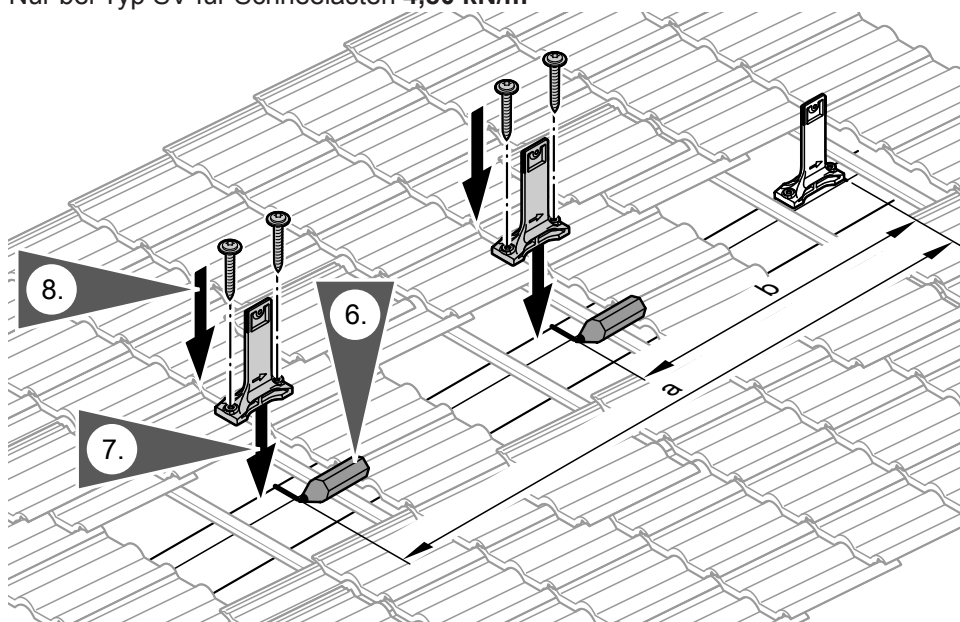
3 Sparrenanker übereinander montieren, Maß b mitteln.
